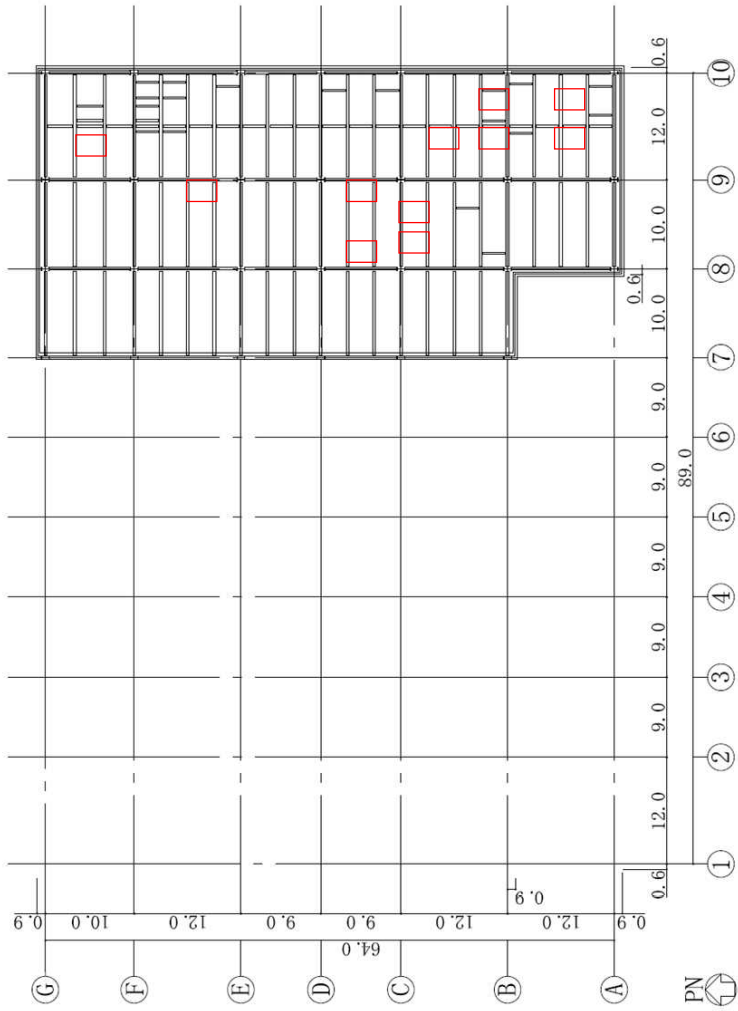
屋上階平面図 (G.L.+10.3) (単位 : m)
